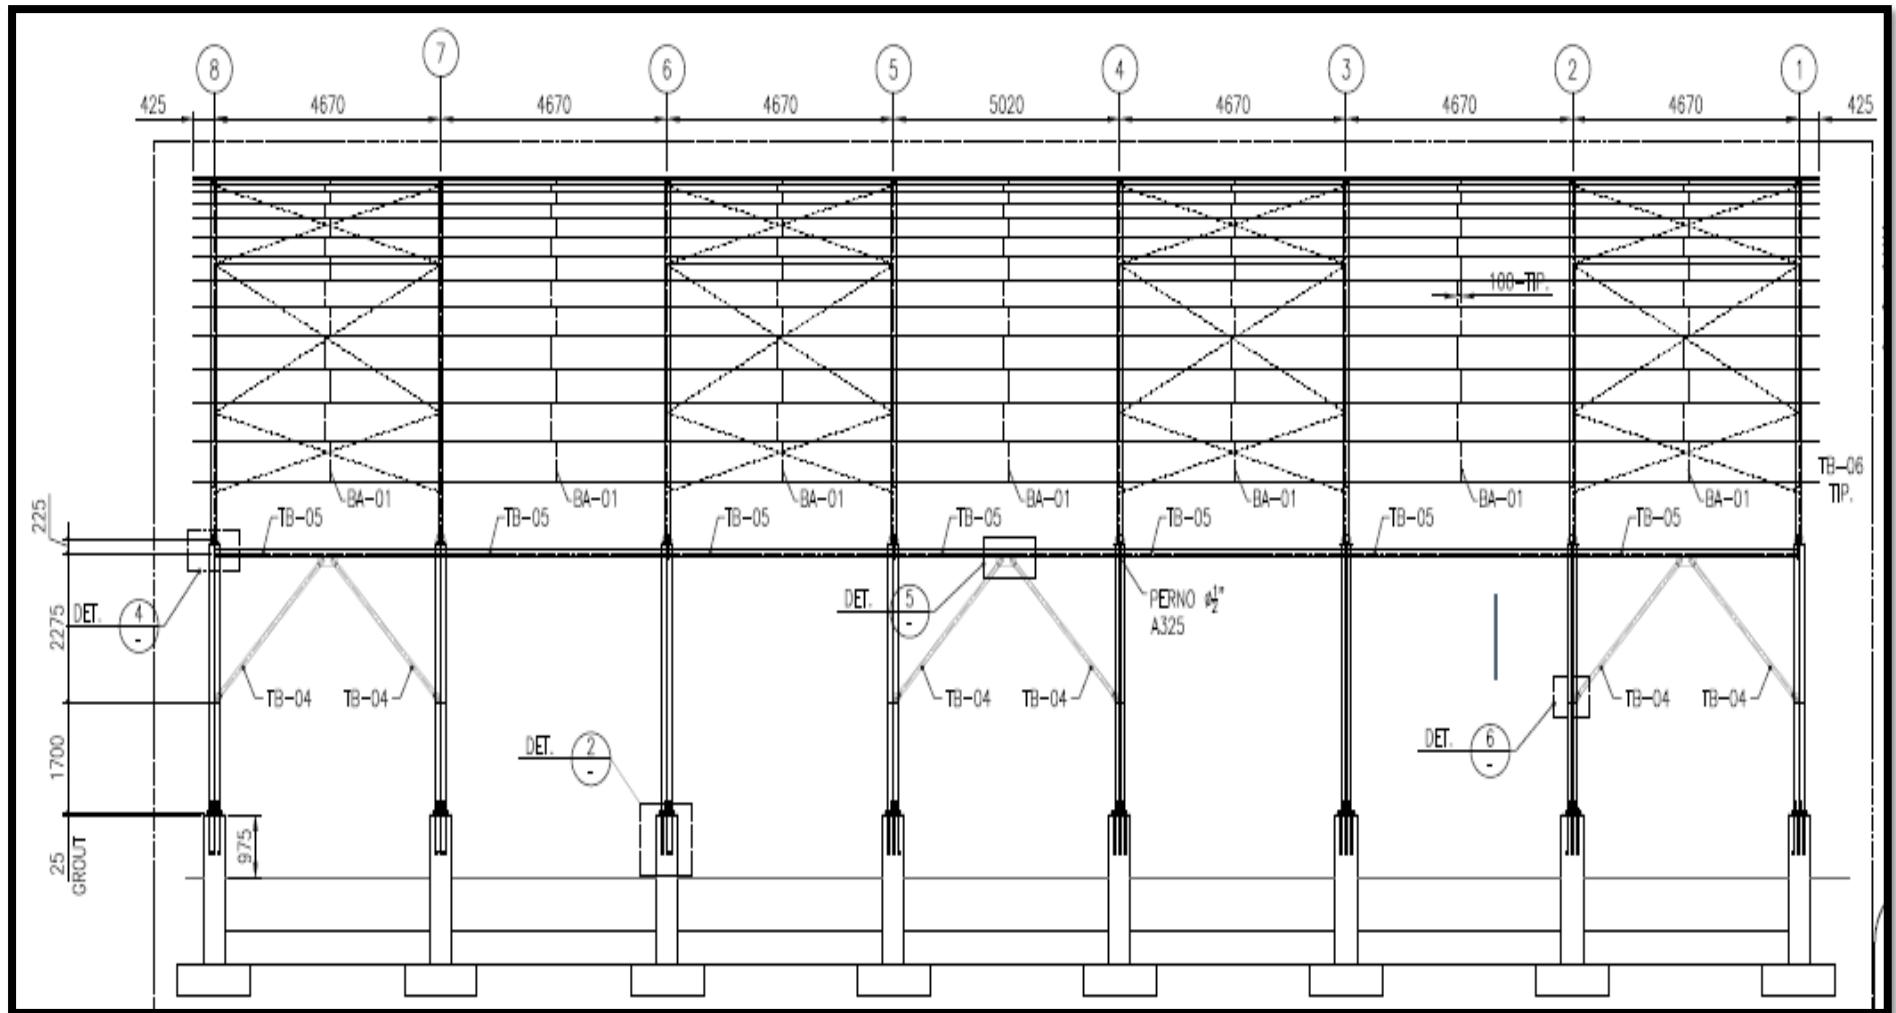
IMAGEN: VISTA PERFIL LADO IZQUIERDO DE ESTRUCTURA METALICA EJE B-B
